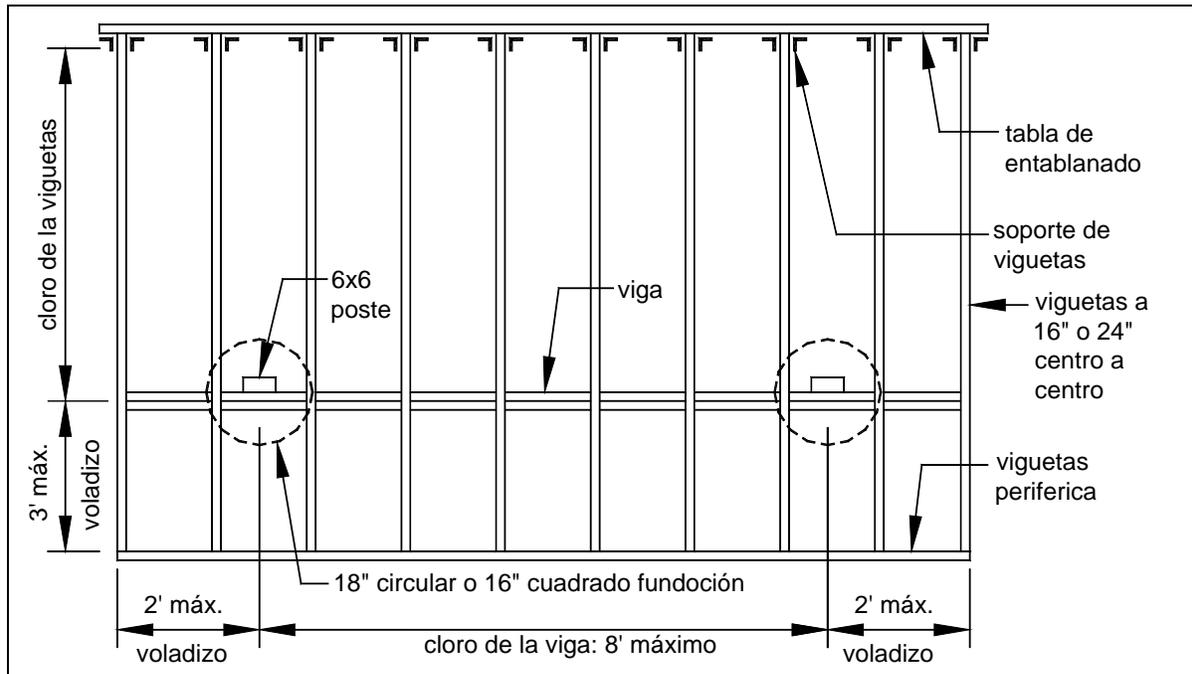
TÍPICO PLAN DE ARMADO DE LA PLATAFORMA
